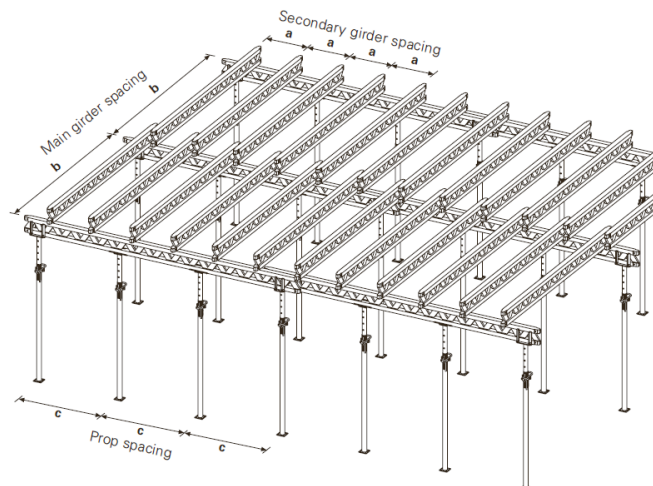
Esquema de colocação de vigas e prumos em sistema MULTIFLEX da Peri
